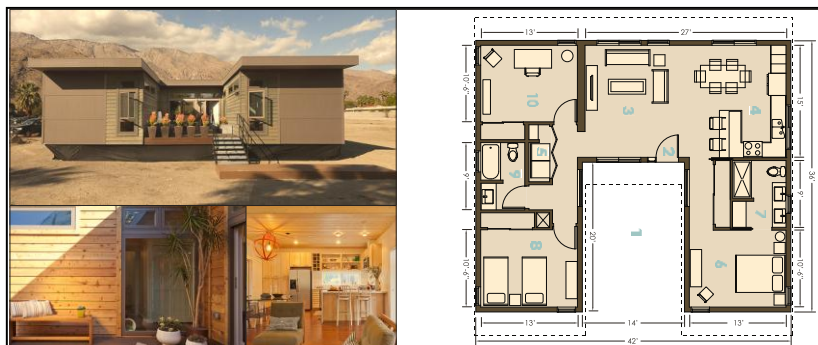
Living Home - C6 – volume, planta baixa e detalhes internos (<http://www.livinghomes.net>)
